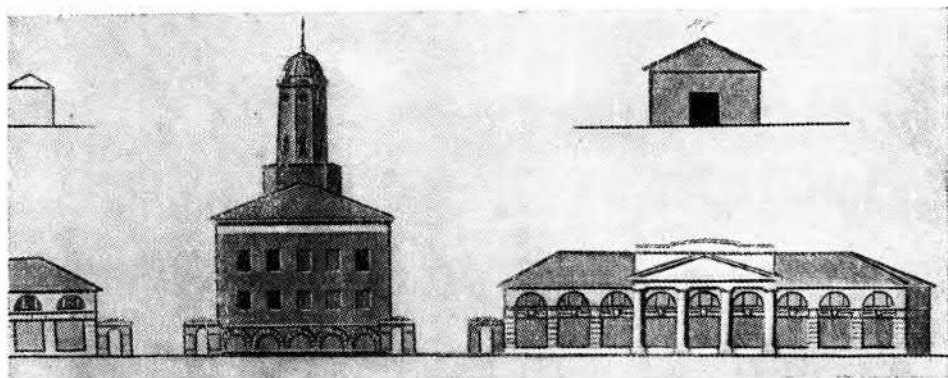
Пожарное депо, фасад (ЦГАДА).
